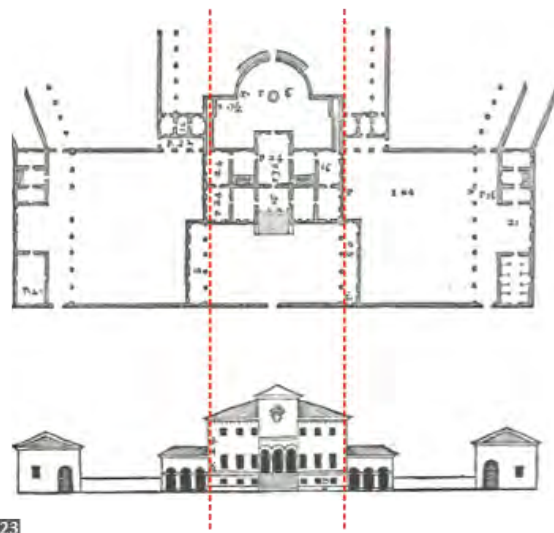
planta baixa e fachada da Villa Godi apresentadas no tratado
